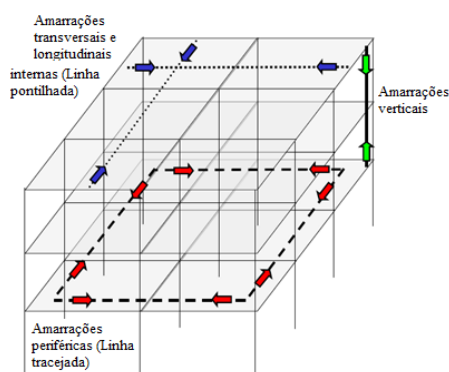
Tipos de amarrações (Adaptado de UFC 04-23-03 (2009)).
